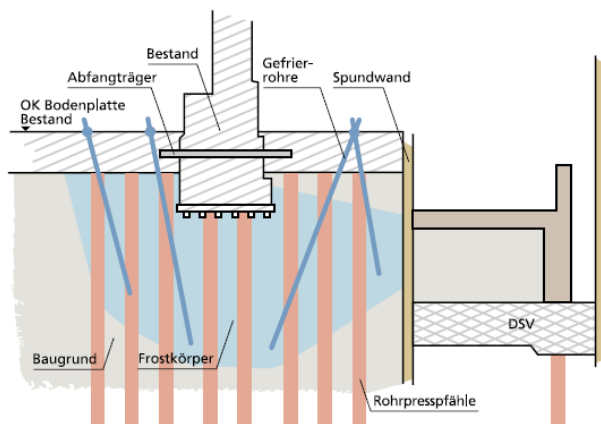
Gefrierinstallation zur südlichen Fassade Neues Museum Berlin
